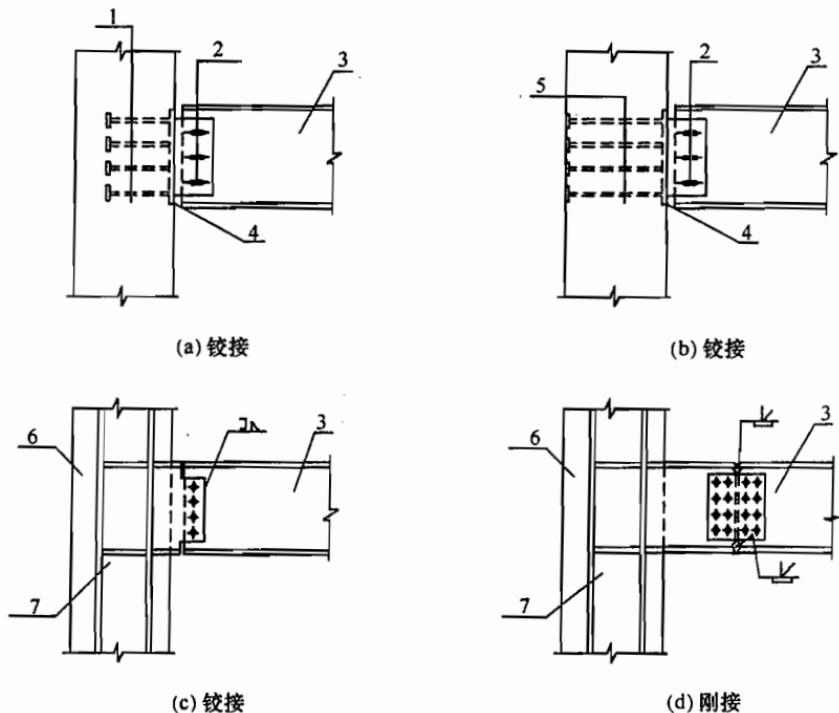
钢梁、型钢混凝土梁与混凝土核心筒的连接构造示意
